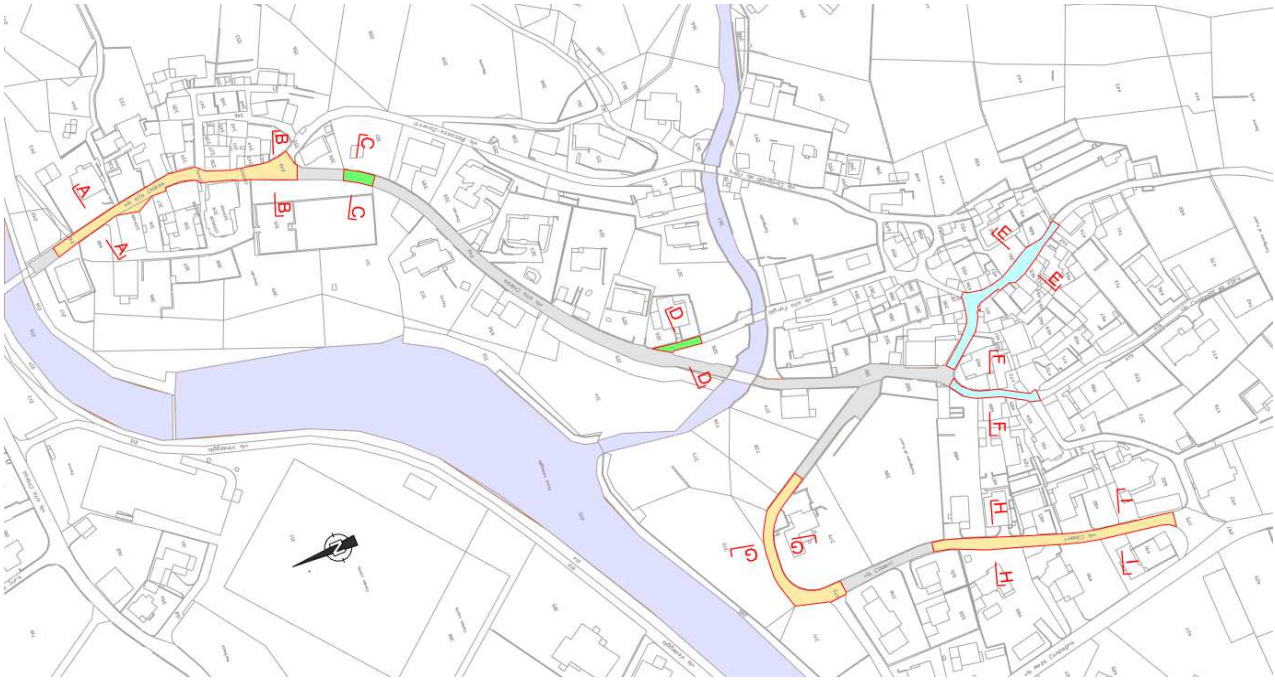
Estratto piano 205 Risanamento pavimentazione
